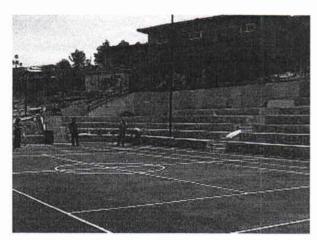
Muros de contención, graderías con mampostería de piedra.
